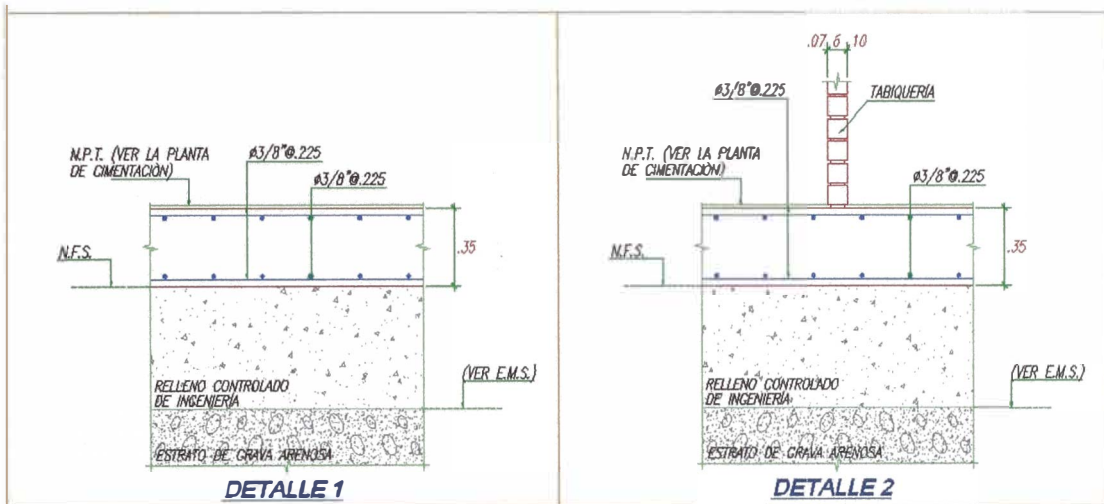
Detalles típicos para placa de cimentación edificio de 9 pisos
